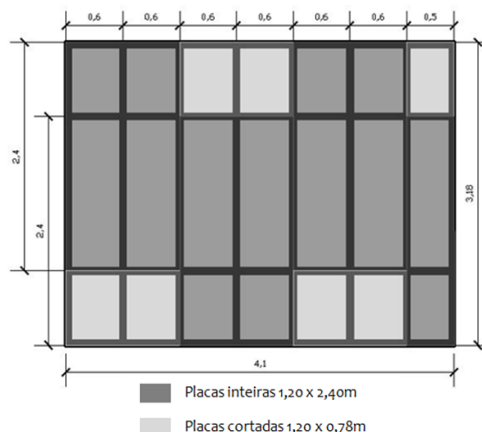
Modulação da estrutura e das placas de revestimento na parede em *light steel frame*.
